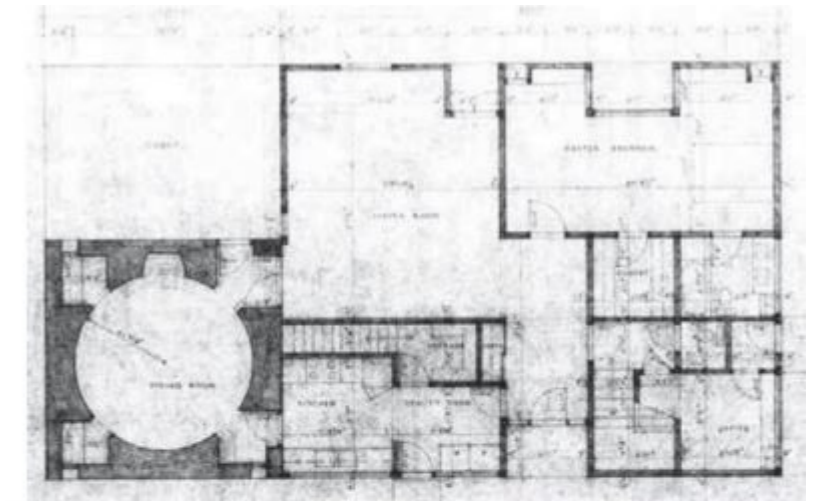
Primeros esquemas (marzo de 1962) Planta baja y Alzado Noreste. Estos esquemas no fueron la versión definitiva de la vivienda.
